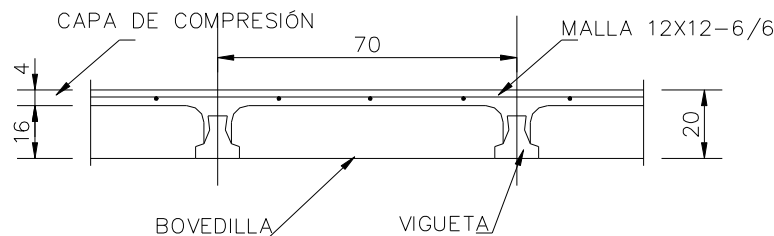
Detalle de sistema de vigueta y bovedilla
